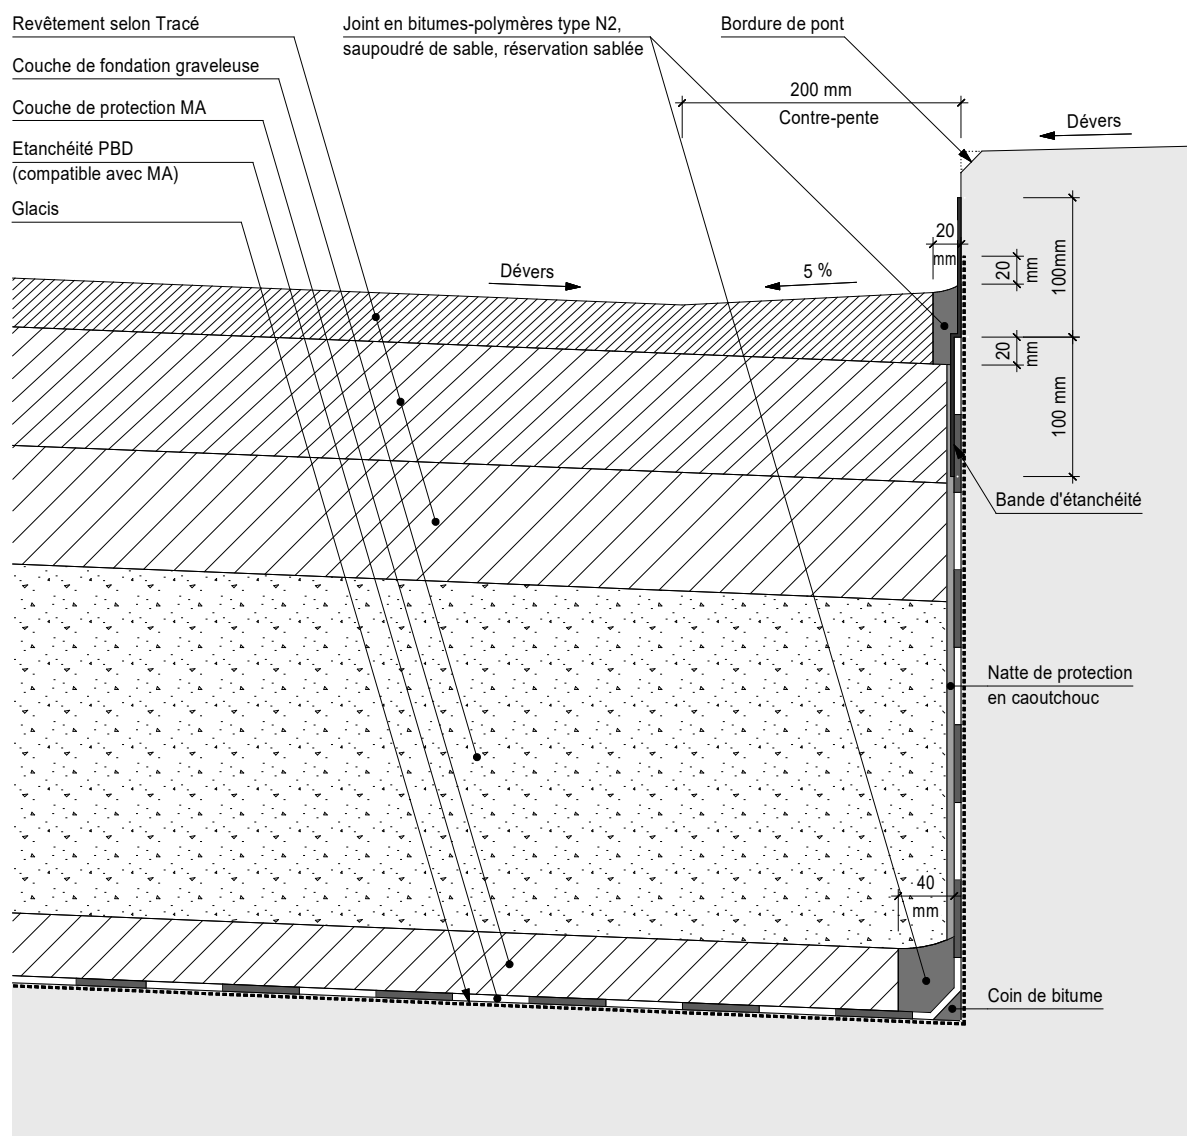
Système d'étanchéité PBD - Pont avec fondation graveleuse – Point bas
